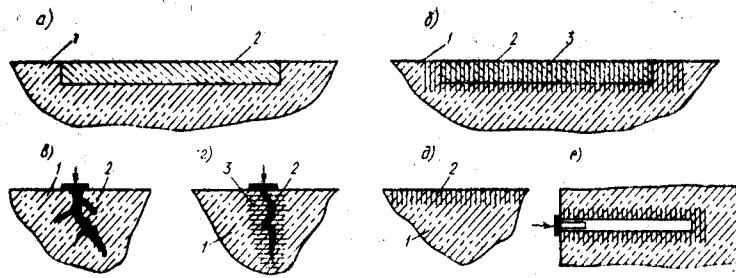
Схемы ремонта поврежденных бетонных и железобетонных конструкций:
